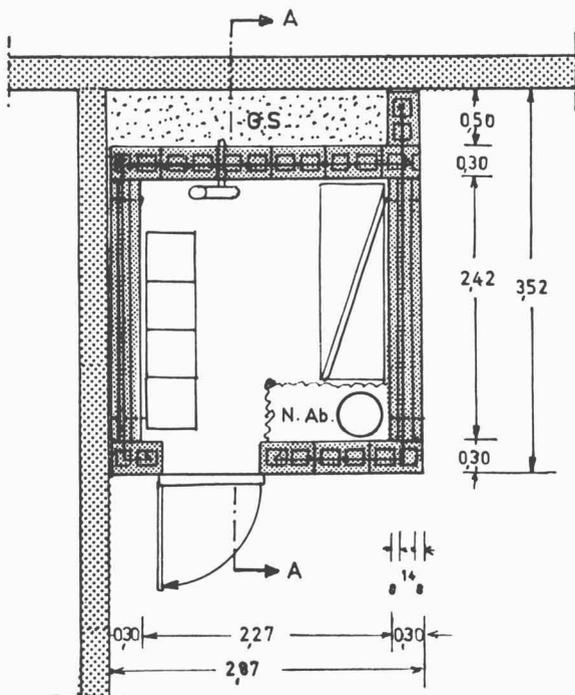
Behelfsschutzbau aus Hohlblocksteinen u. Stahlbetonfertigträgern
